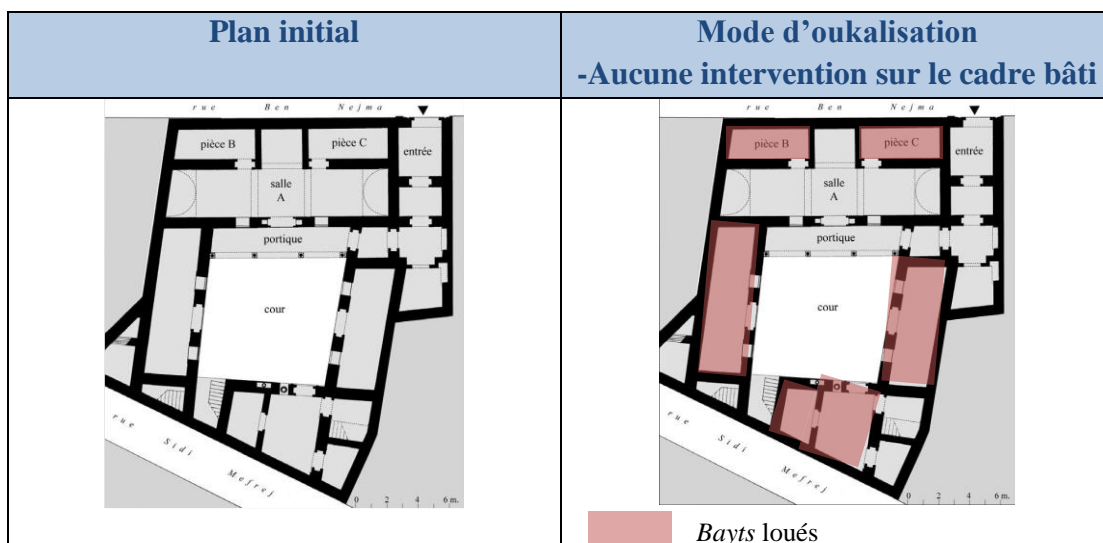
Plan d'oukalisation des premières oukalas. (Source: Hamrouni, 2022)
